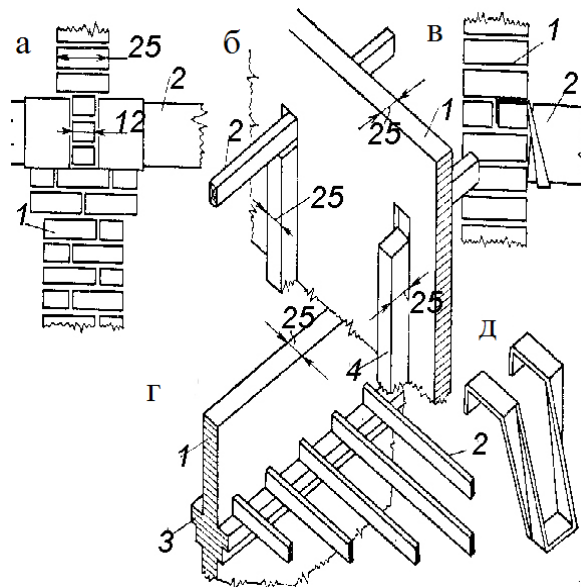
Правила спирання конструкцій на цегляну протипожежну стіну: а – закладення балок у стіну; б – обпирання балок на пілястру; в – підвіска балок на хомутах; г – обпирання балок на консоль; д – хомут; 1 – протипожежна стіна; 2 – балка; 3 – консоль; 4 – пілястри
